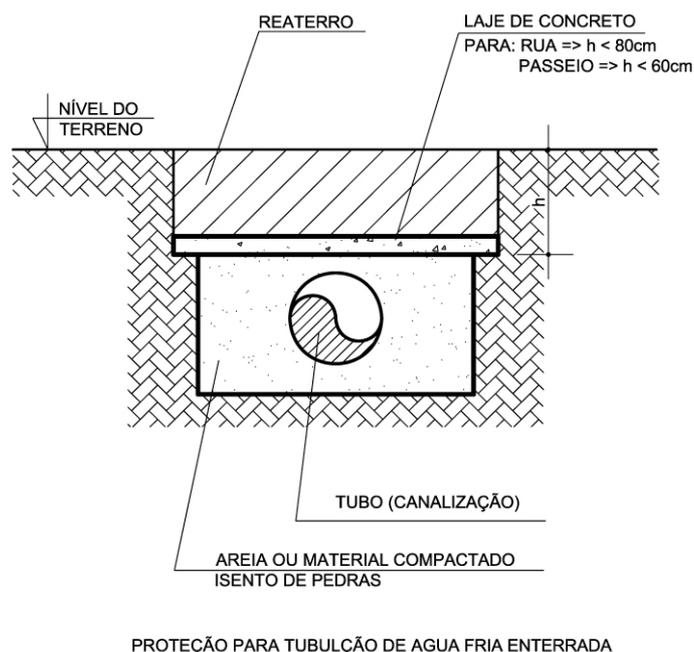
Proteção da canalização em vala c/ recobrimento menor do que 30 cm.
